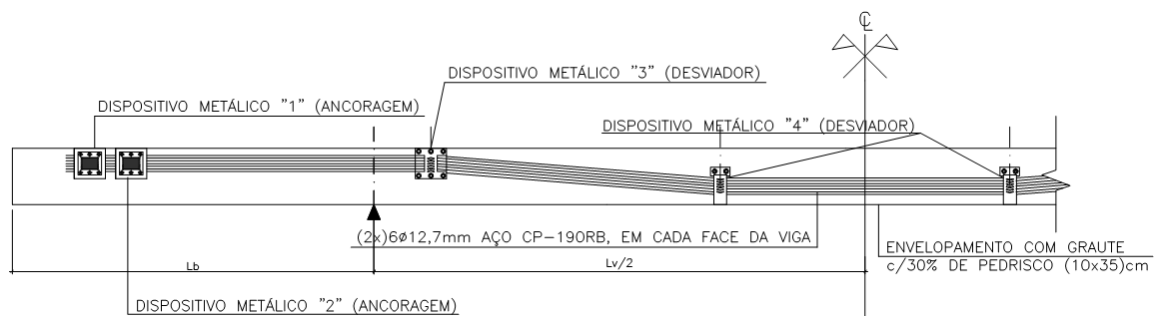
$\frac{1}{2}$ vista longitudinal do traçado da protensão externa nas vigas.
